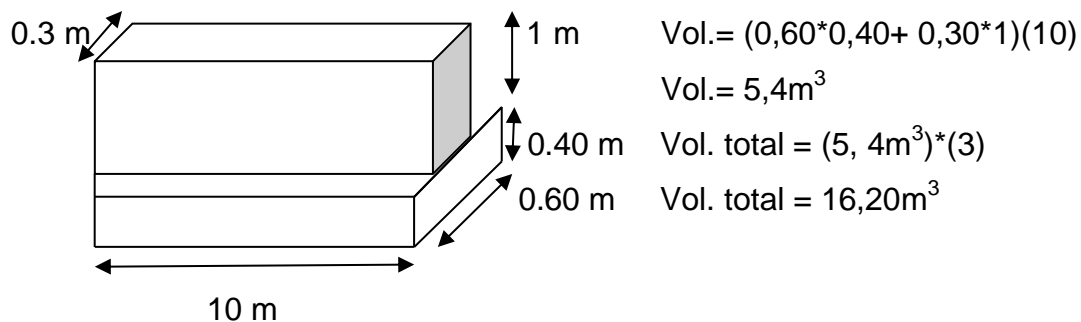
Construcción de muros en el desnivel de la parte superior del cerro
